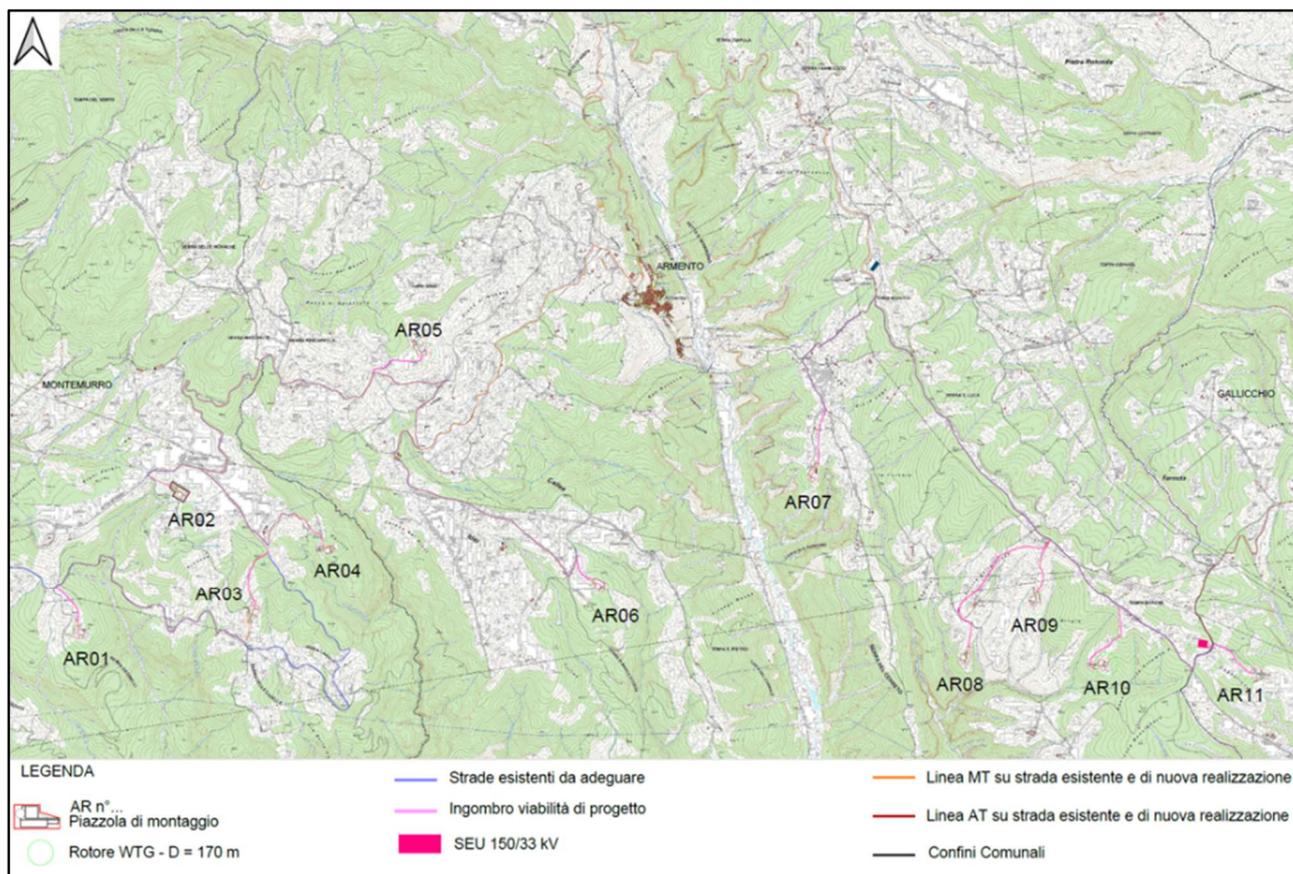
Layout d'impianto con viabilità di progetto e linee elettriche MT su CTR
